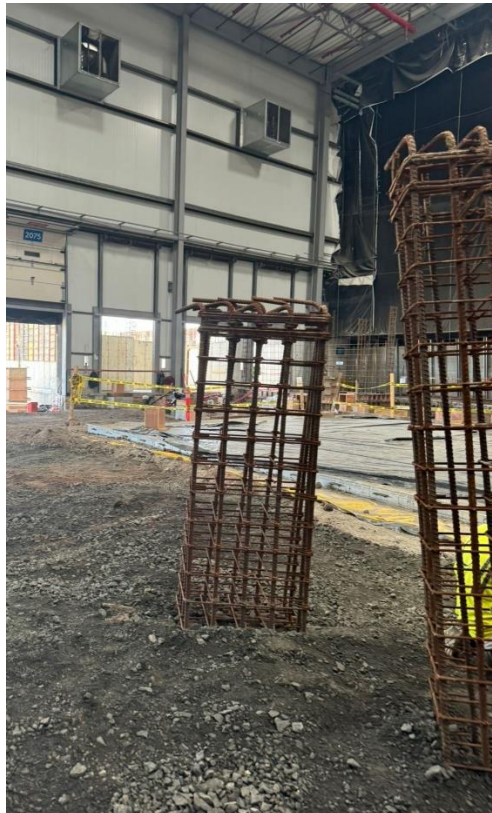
Estructura metálica para construcción de mezzanine en zona de comedor de asociados.
